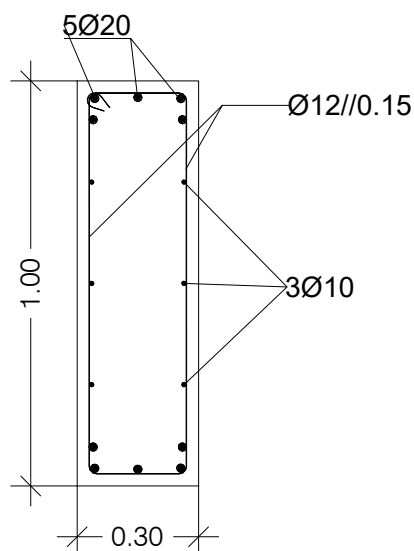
Secção transversal da viga de acoplamento PA_75%
